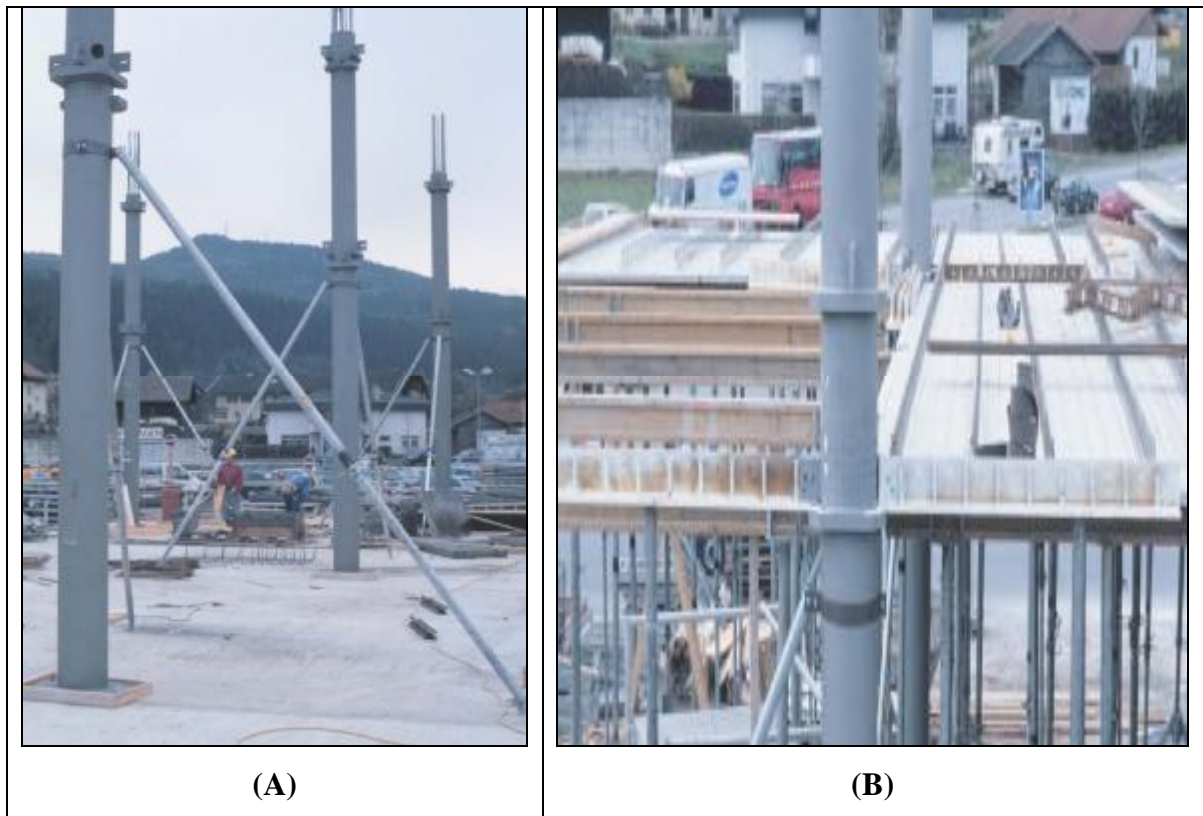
(A)-Elévation de poteaux mixtes sur 2 étages
